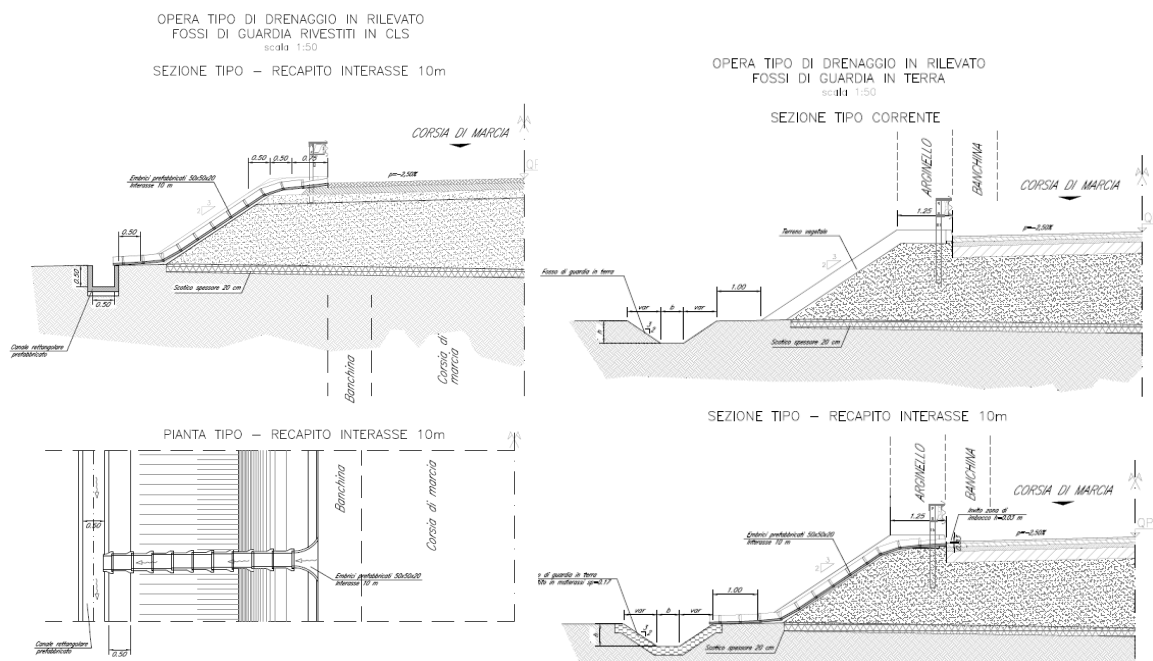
NV18 - Rilevato - Opere tipo di drenaggio
